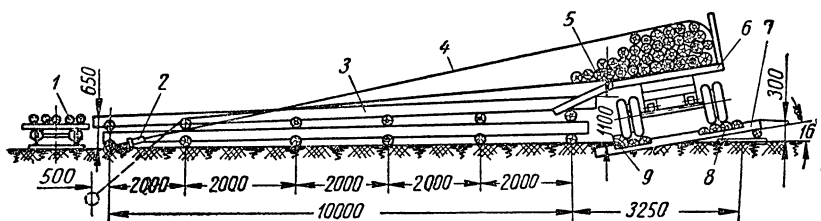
Схема разгрузочной эстакады для автомобиля МАЗ-501, оборудованной приспособлением для стаскивания хлыстов:
